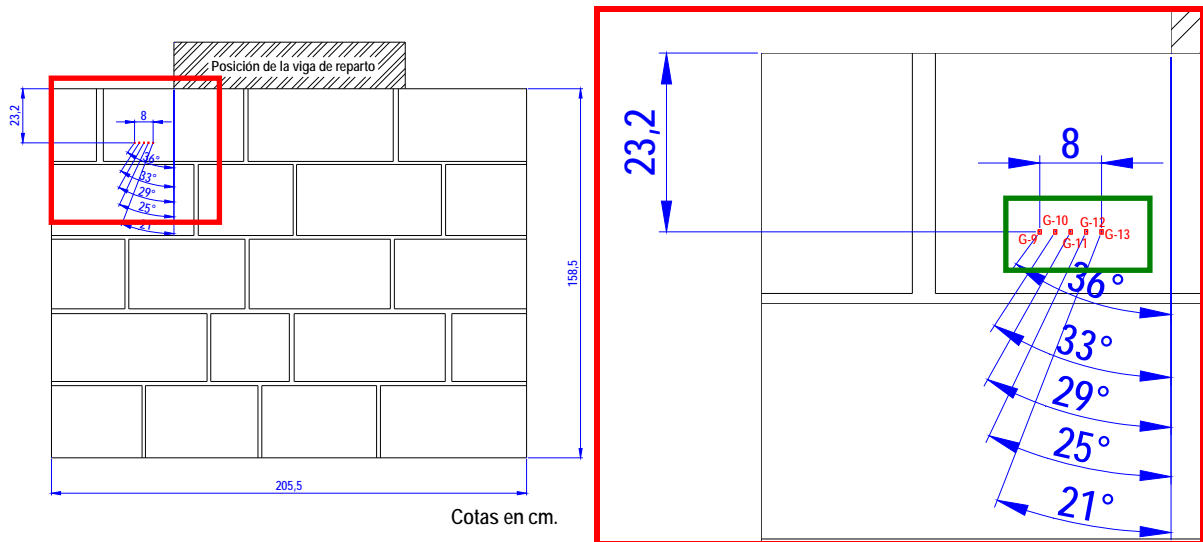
y 4.1.15: Detalles de la localización de las galgas extensométricas en el seno del muro de sillería.
